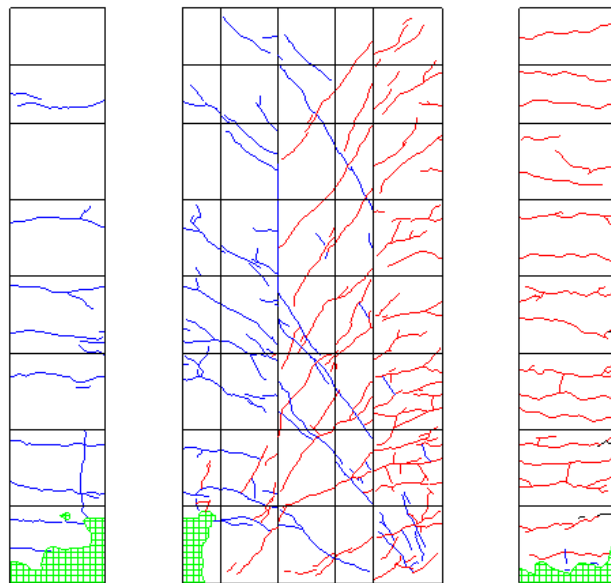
R=-1/33②ひび割れ図
